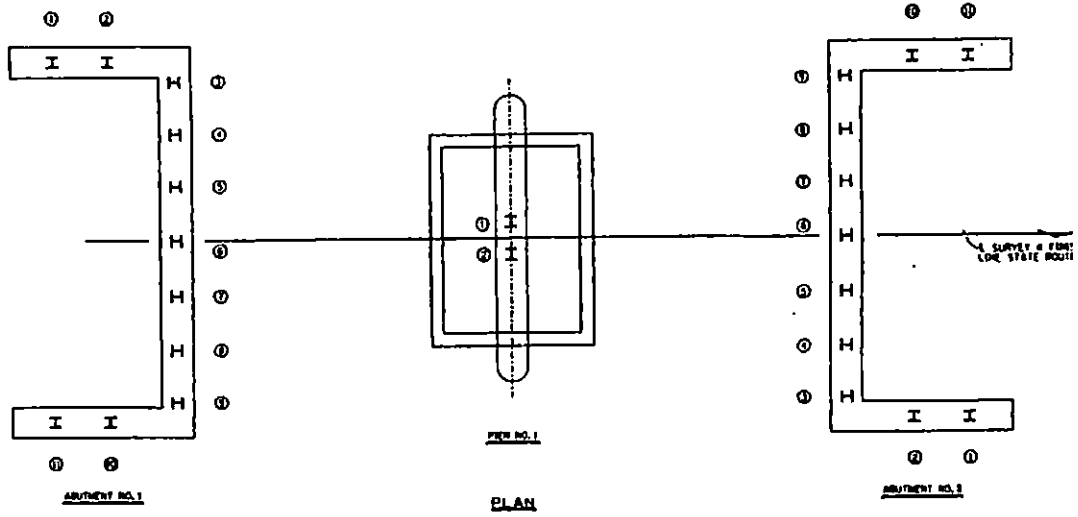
VISTA EN PLANTA DE LA FUNDACION.
